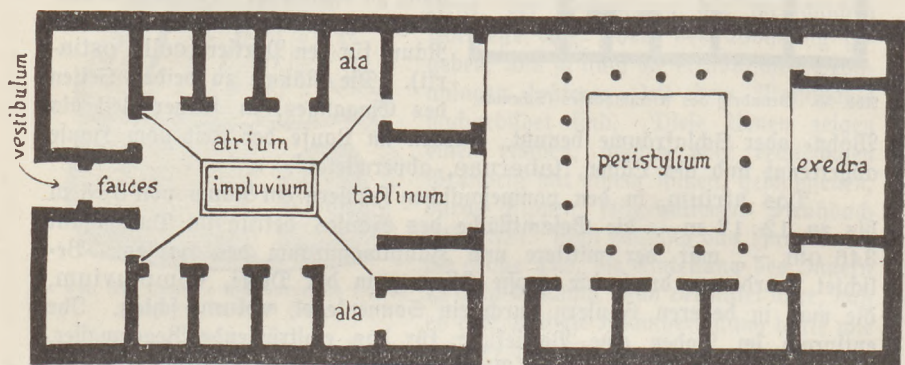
Grundriß des Atrium-Peristylhauses (Schema).
